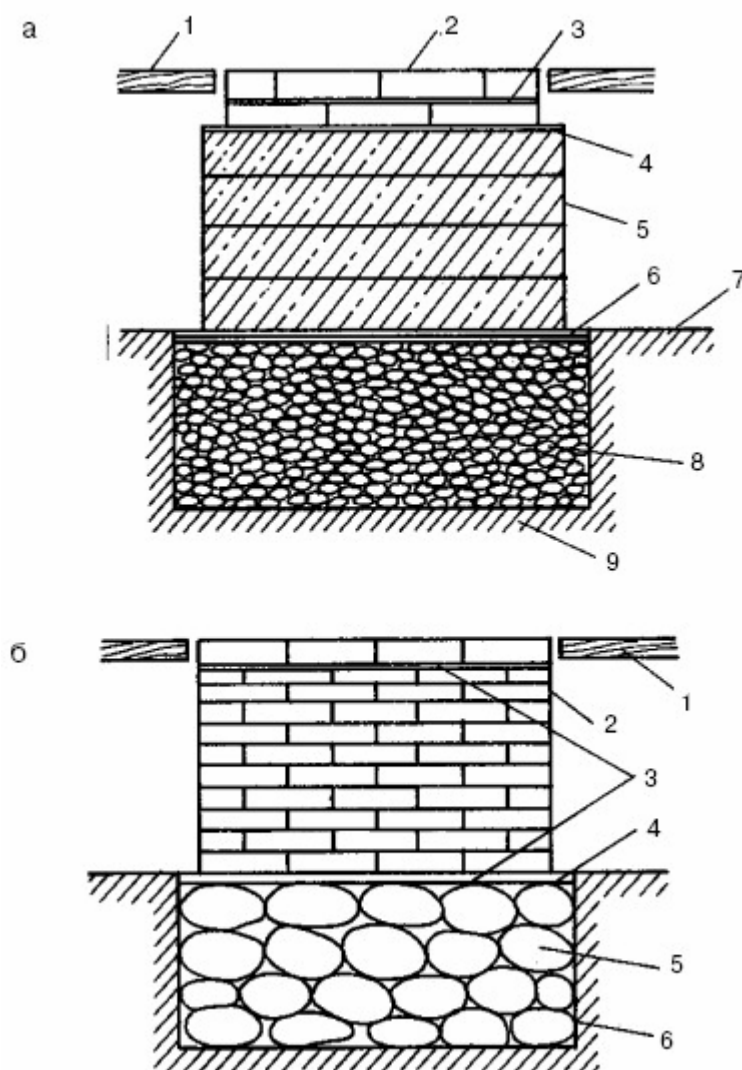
Сплошные фундаменты для печей: а – фундамент из мелкого камня, гравия и кирпичной щебенки: 1 – пол; 2 – два ряда кирпичной кладки; 3, 6 – гидроизоляция; 4, 7 – выравнивающие слои из цементного раствора; 5 – наружный фундамент из шлакобетона; 8 – фундамент в грунте из кирпичного щебня и гравия; 9 – грунт; б – фундамент из бутового камня и кирпичной кладки: 1 – пол; 2 – кирпичная кладка; 3 – гидроизоляция; 4 – выравнивающий слой; 5 – фундамент; 6 – грунт
